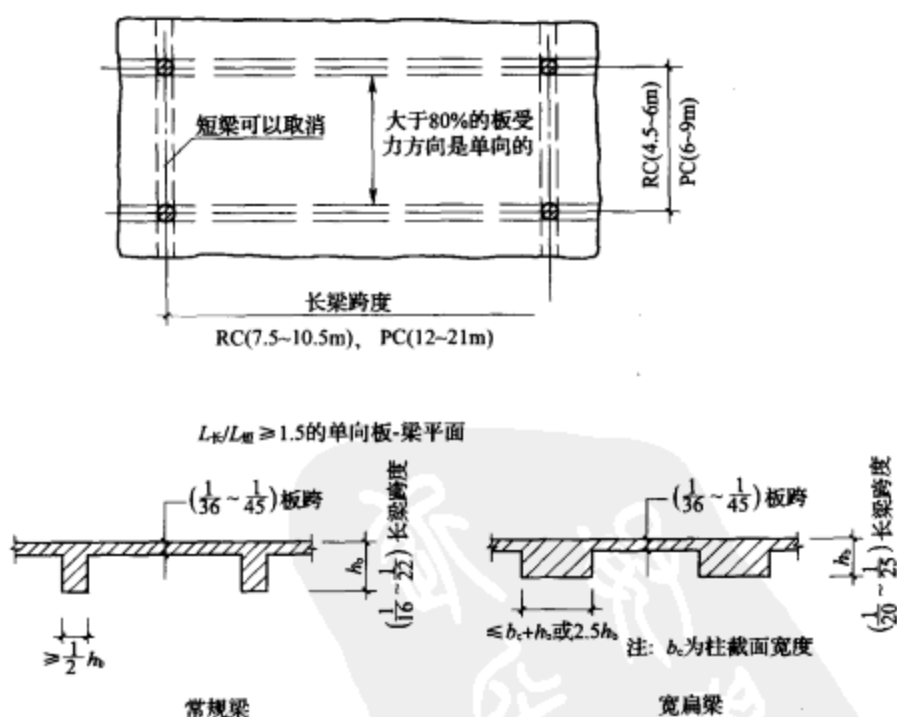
钢筋混凝土或预应力混凝土单向板-梁结构初步设计
